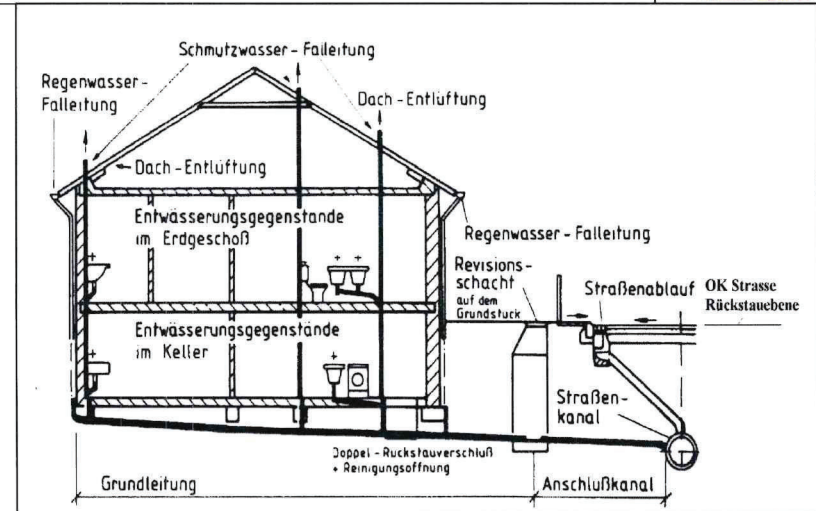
Gebäudeentwässerung (Mischsystem) mit Straßenentwässerung
